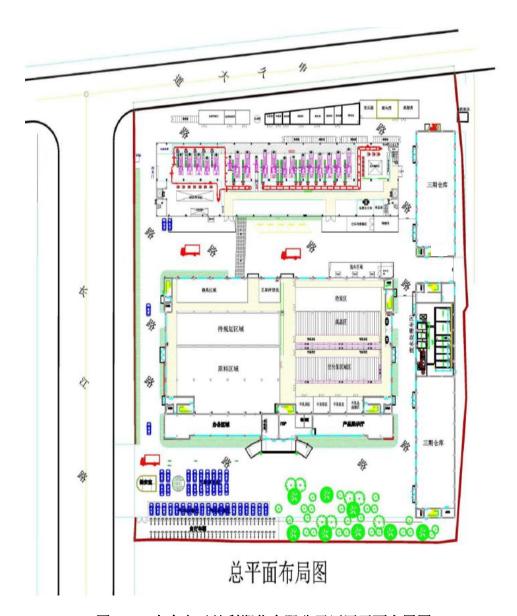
太仓市天丝利塑化有限公司厂区平面布置图
